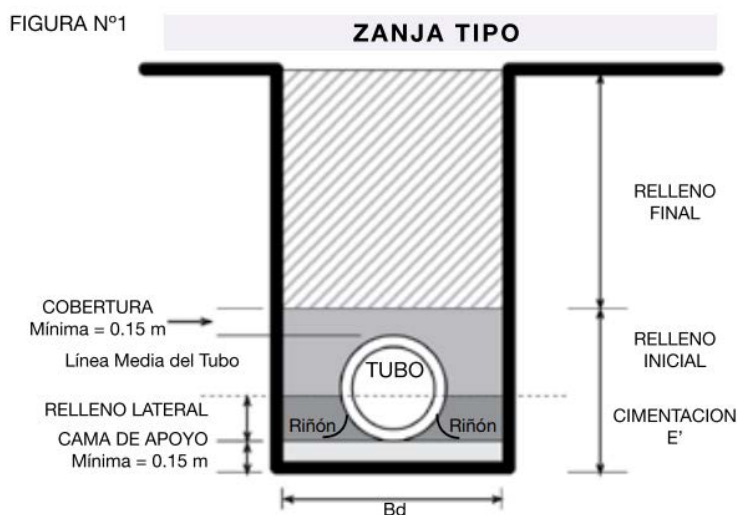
Zanja para tubería (Pavco Wavin, 2020)
